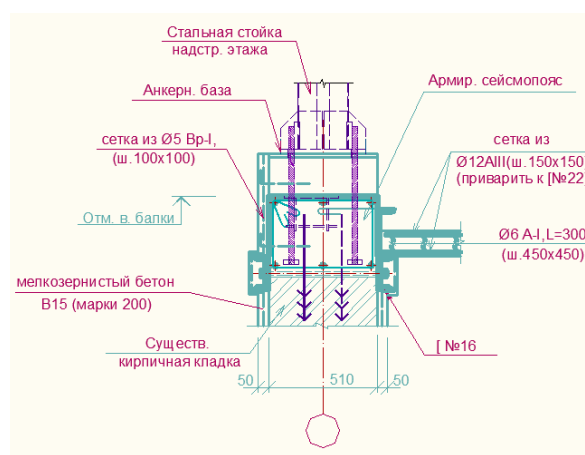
Узел крепления стального каркаса надстраиваемого этажа
